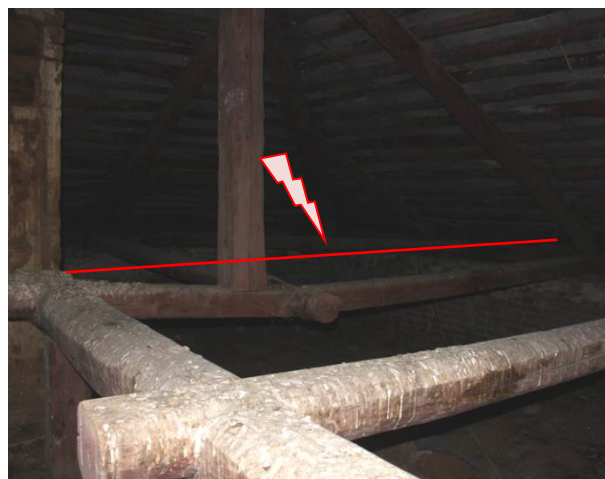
Фрагмент подстропильных балок в осях 6/1-8. Прогиб подстропильной балки в осях (6/1-8)/(Б-В) более 200 мм из-за перегрузки от стойки диагональной стропильной ноги
